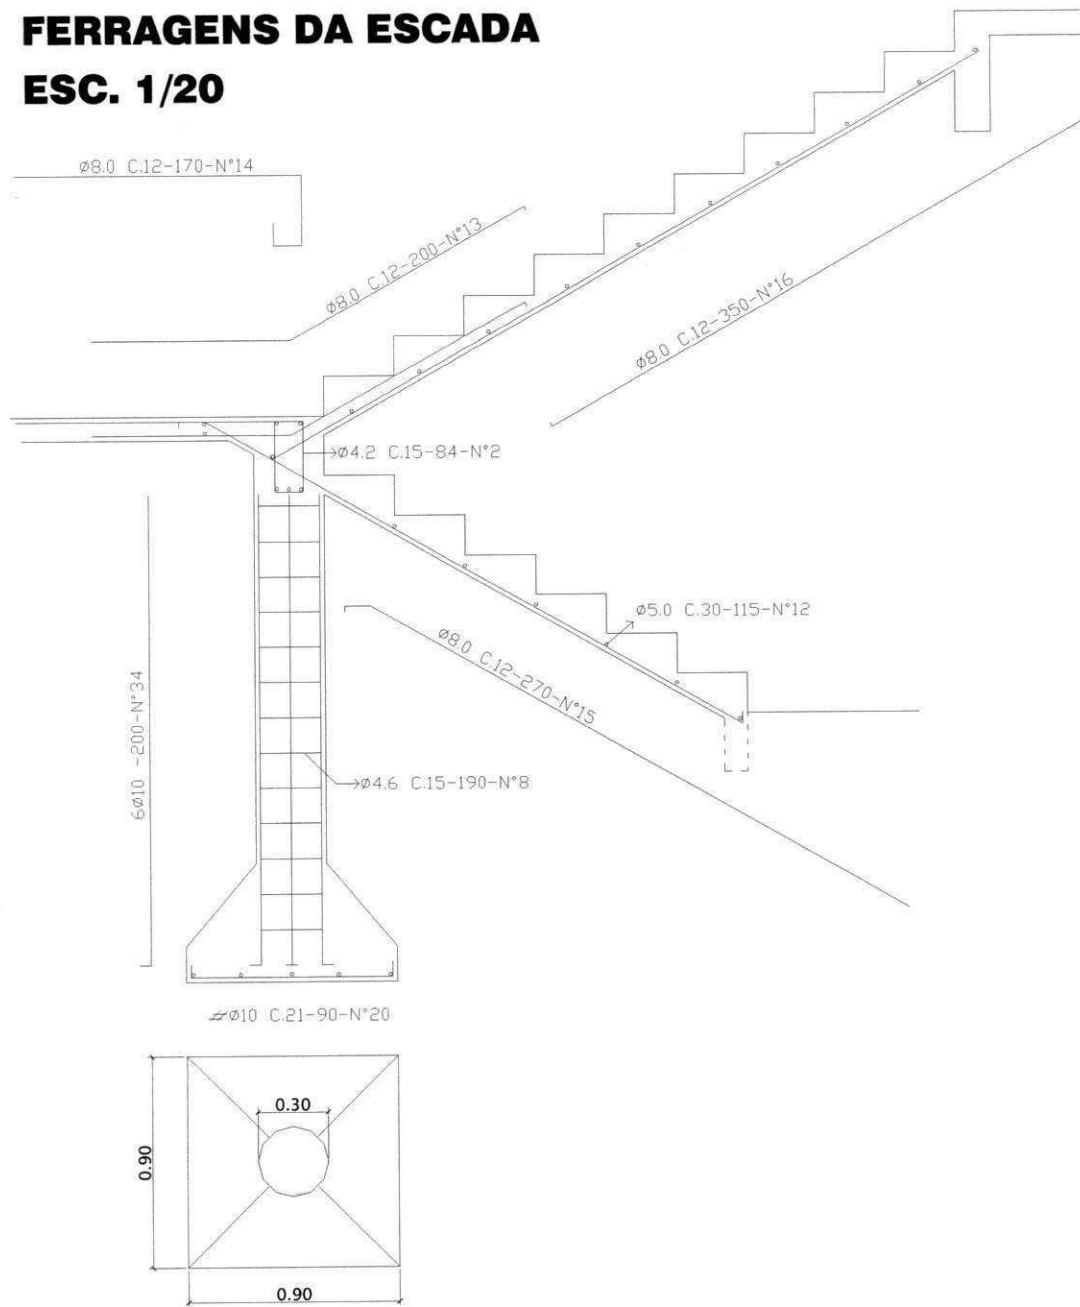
Ferragem do pilar da escada da Quadra poliesportiva do Complexo Integrado
